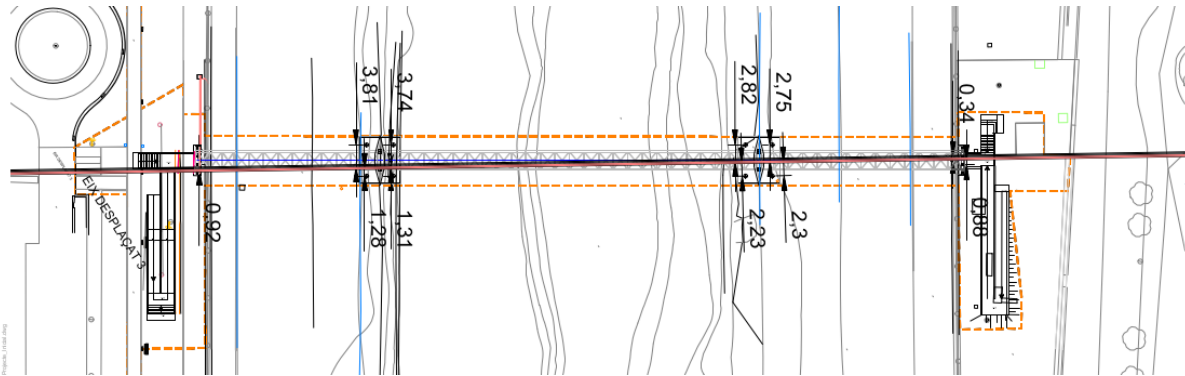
Planta coordinació passarel·la sobre el riu Besòs projectada i escomesa elèctrica existent
